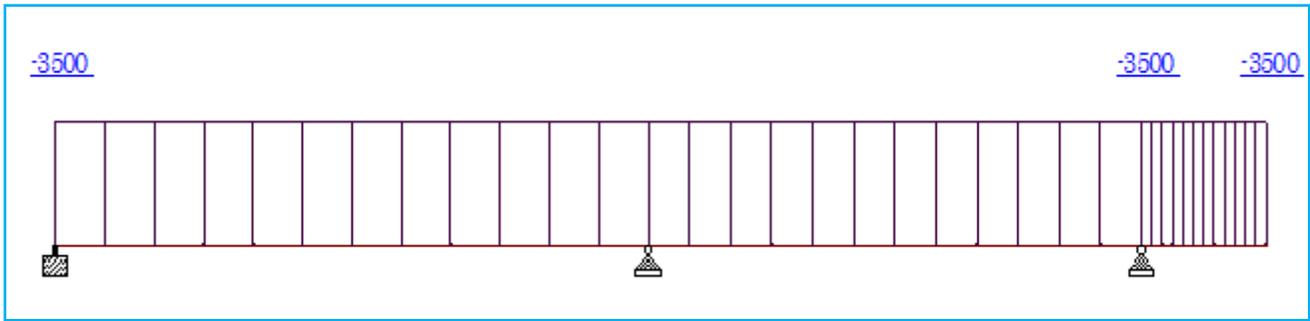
modelo de la viga en el staad pro (kg/m)
